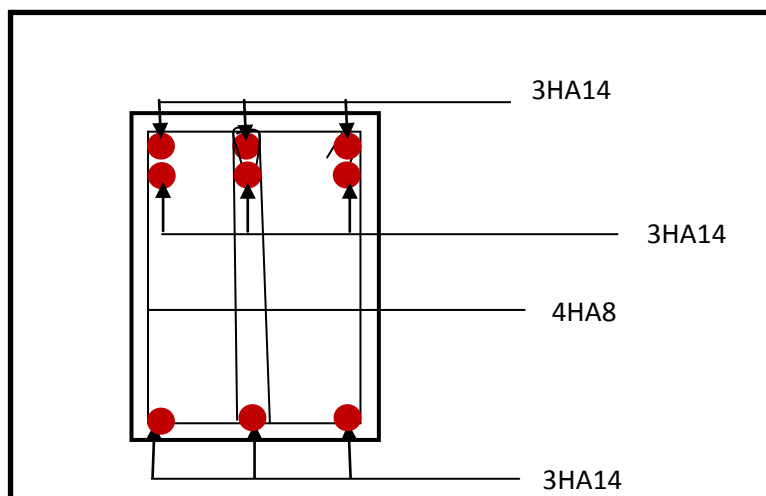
FIGURE VI.: Ferraillage sur appuis d'une poutre principale.
